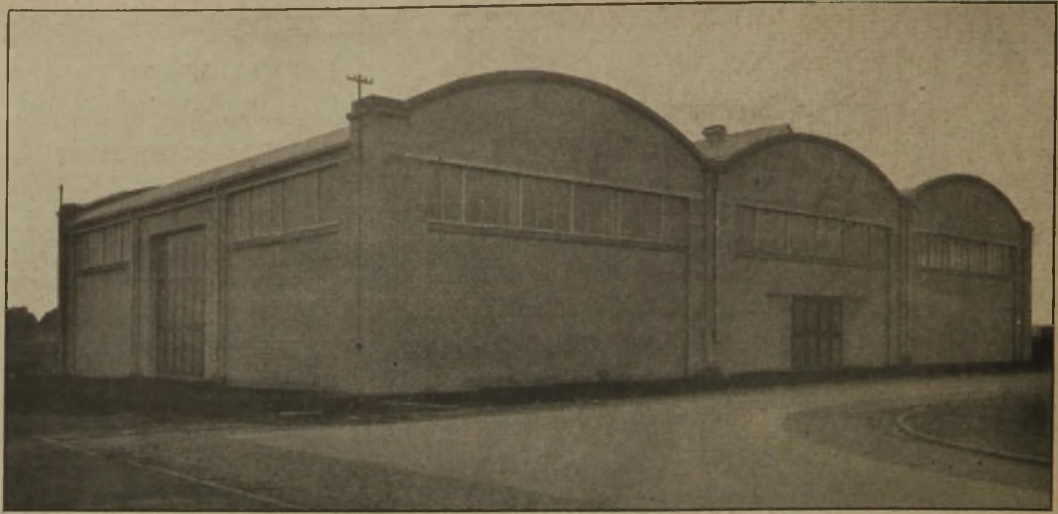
Äußeres einer dreischiffigen Halle mit gebogenem Junkers-Dach.
